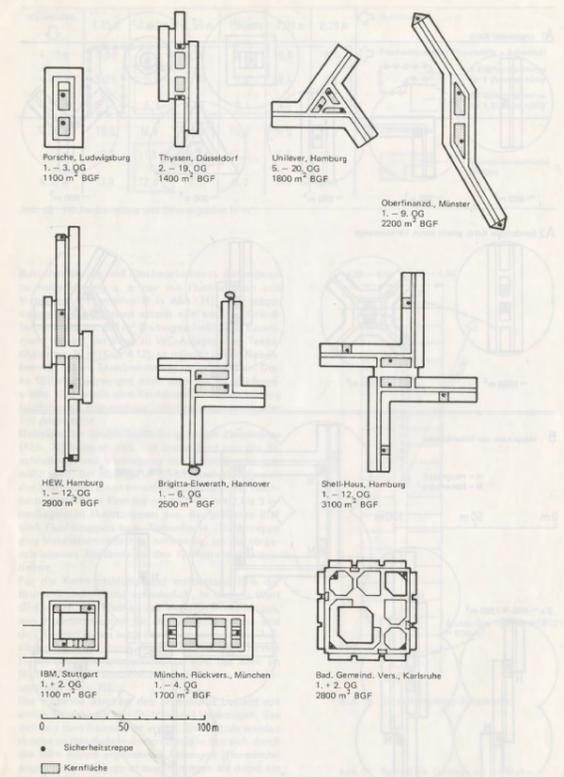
Grundrisselemente und Brutto-Grundriffsflächen (BGF) einiger Zellenbüros
